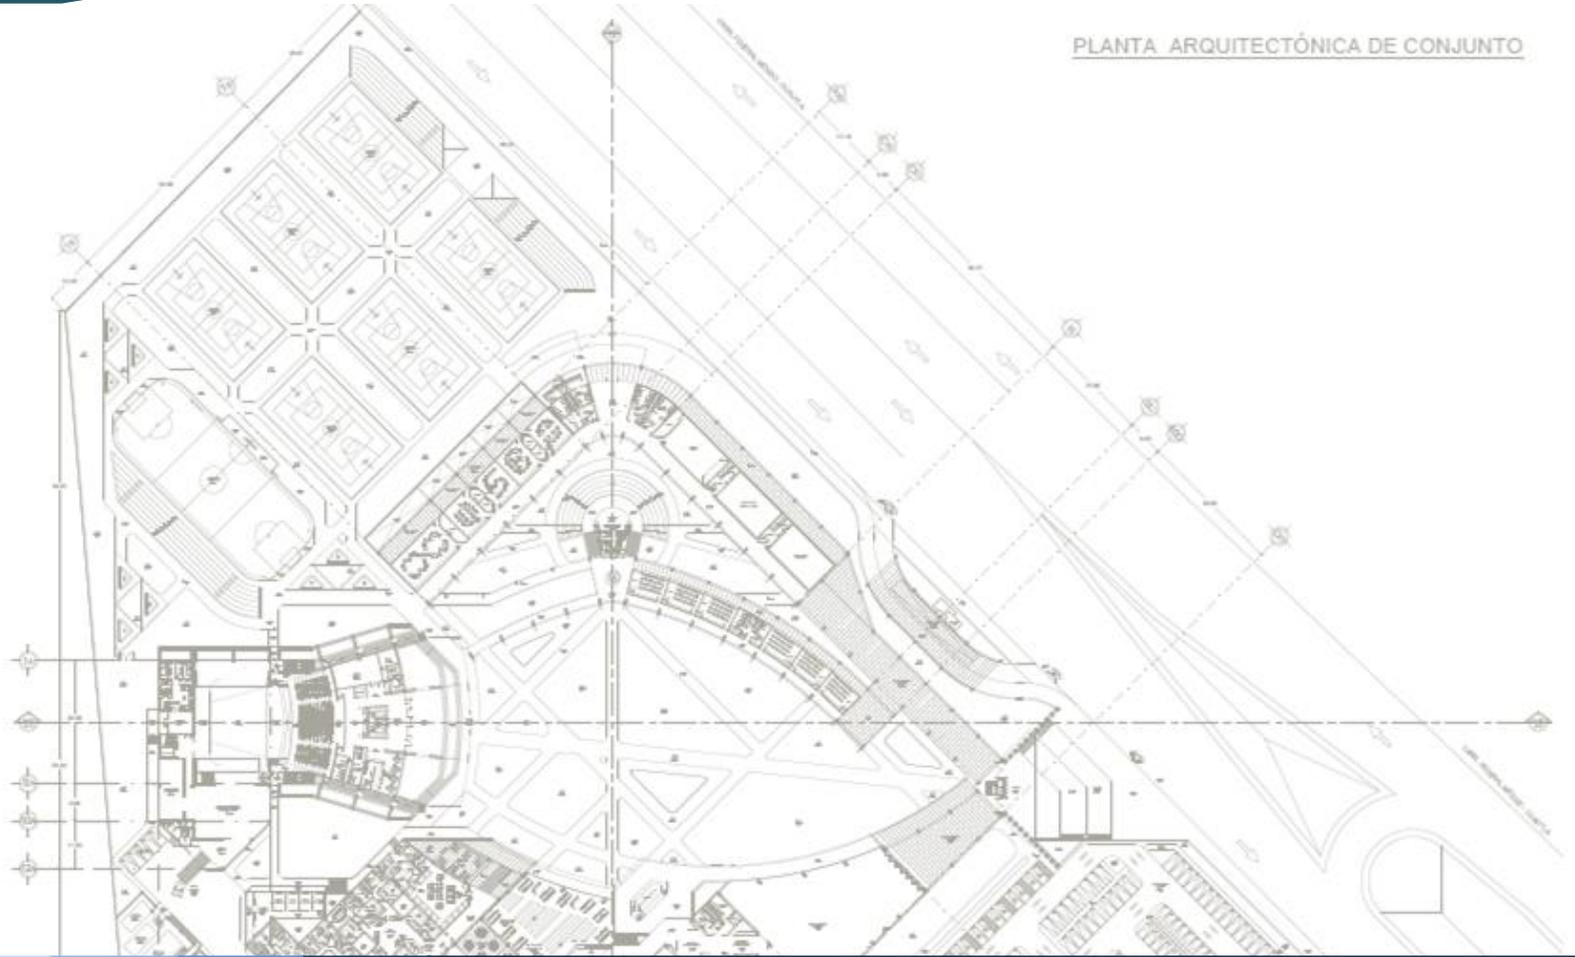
Primera propuesta arquitectónica de conjunto.
